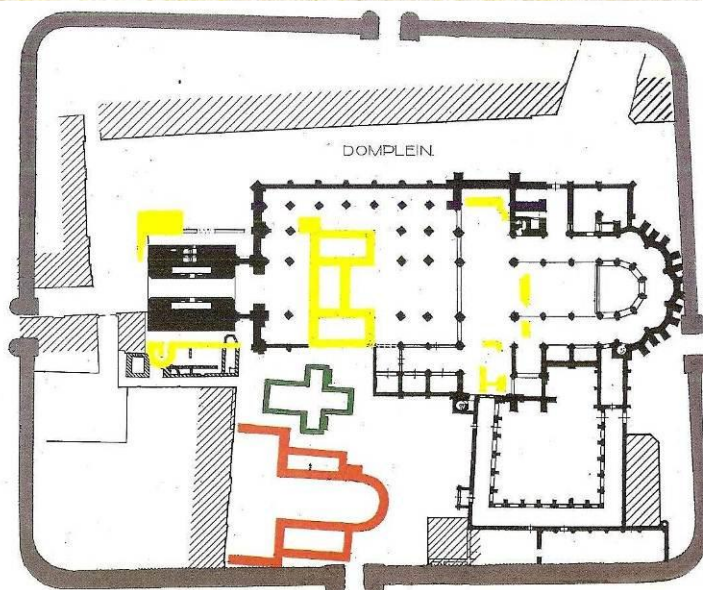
Grundrisse der Kirchenbauten auf dem heutigen Domplatz mit eingezeichneten Fundamentresten des romanischen Domes
